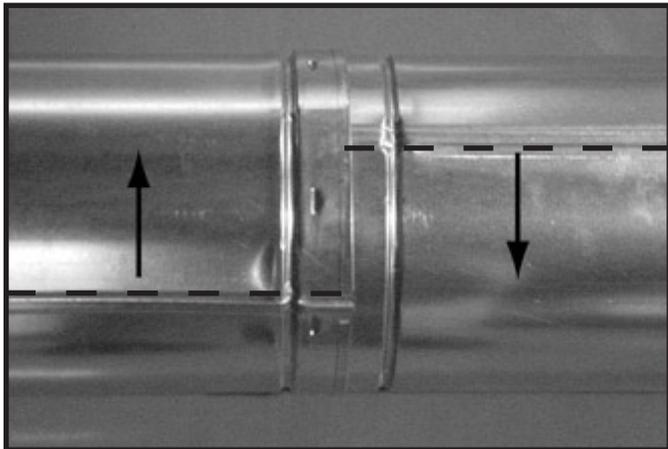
Tournez les cordons de soudure pour démonter
